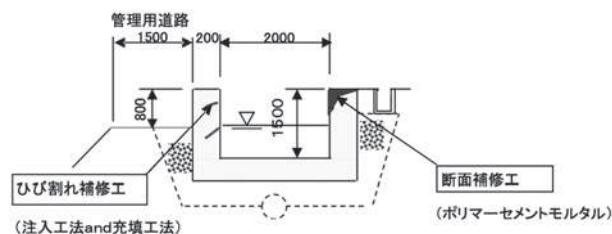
ひび割れ補修(B-1)及び断面補修工法(B-2)概要図
